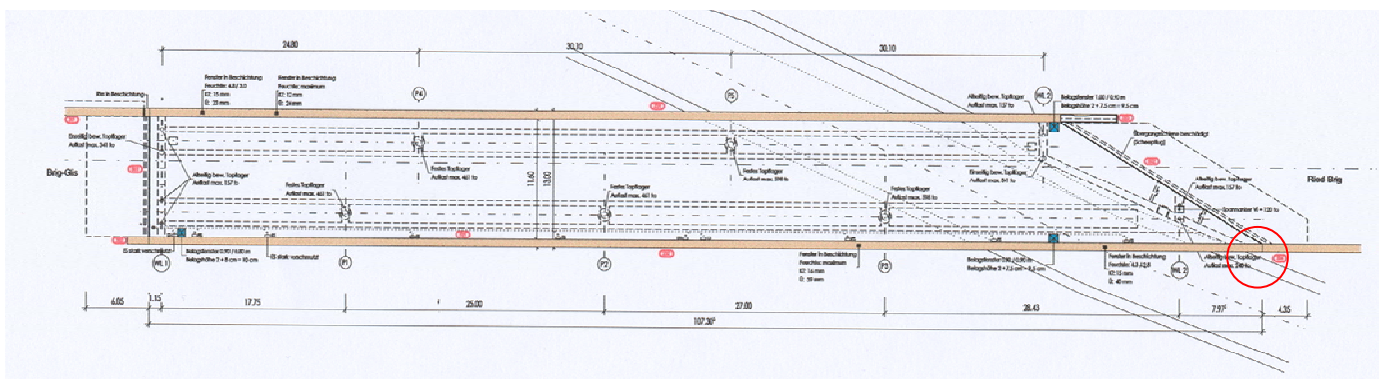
Grundriss Lingwurmbrücke, schiefe Lagerung mit der kritischen Ecke (Kreis)
